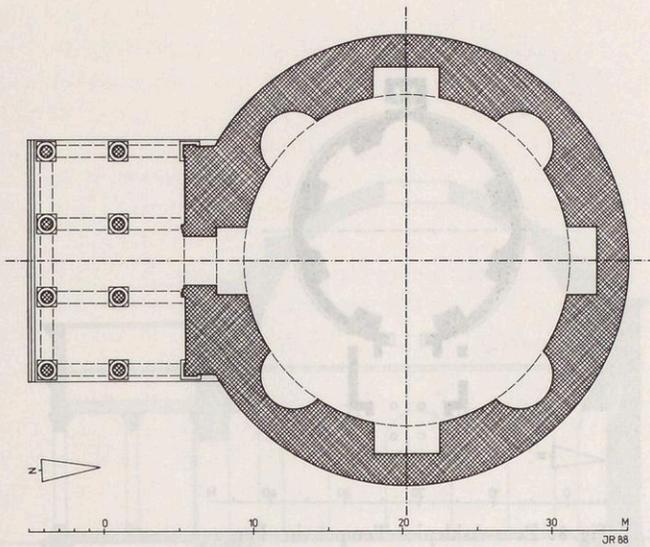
Severische Rotunde, Grundriß, Rekonstruktion, M 1:500
